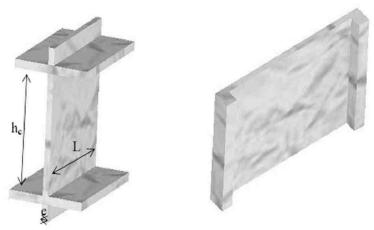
Schéma et dimensions des voiles (Coupe de voile en élévation.).
